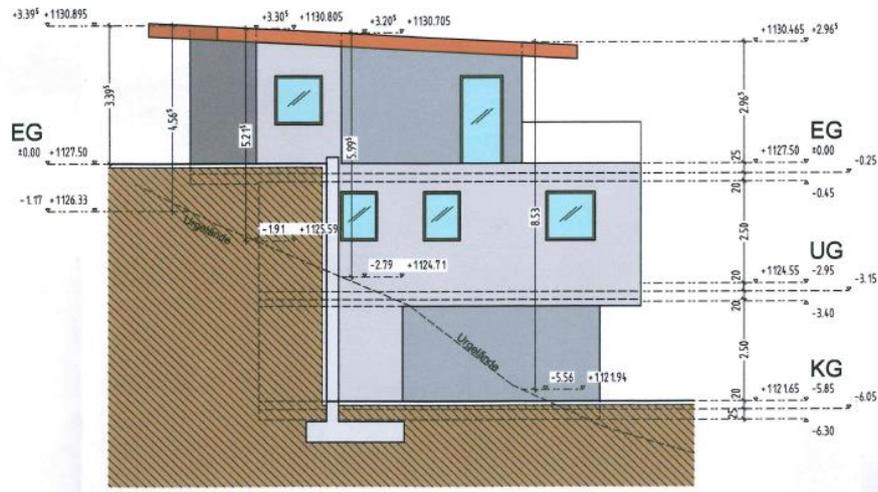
Westansicht – Wohngebäude auf der Gp. 6534 laut Einreichplan des Planungsbüros Josef Pfeifer (ohne Maßstab)
